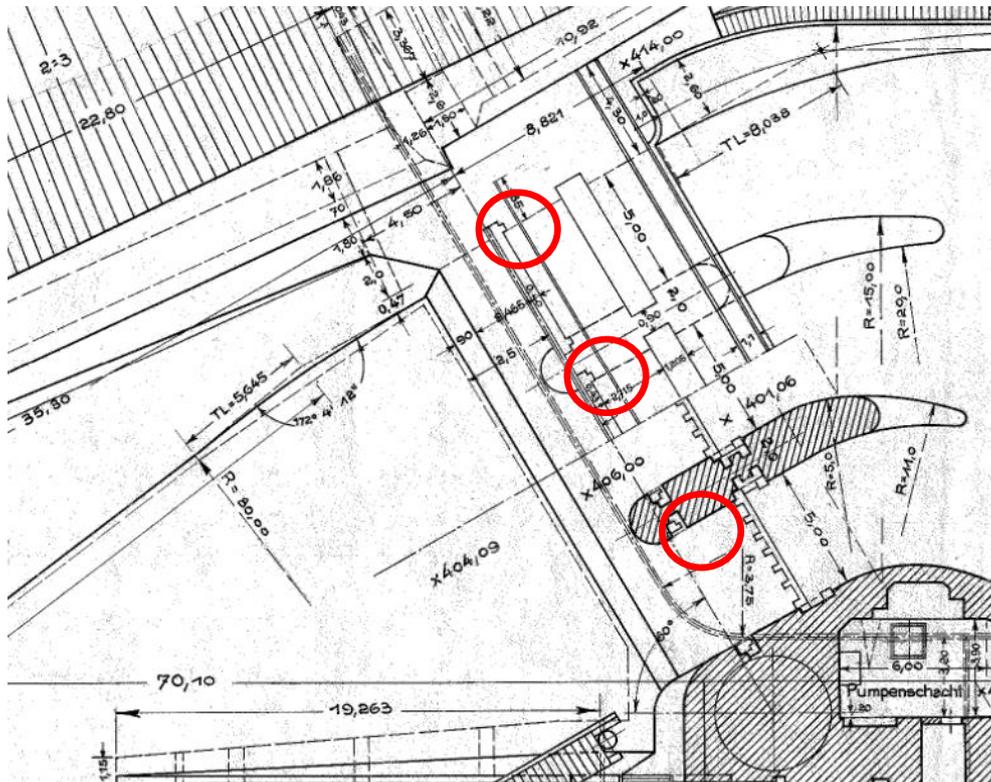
Grundriss Leerschuss WKW UP1
